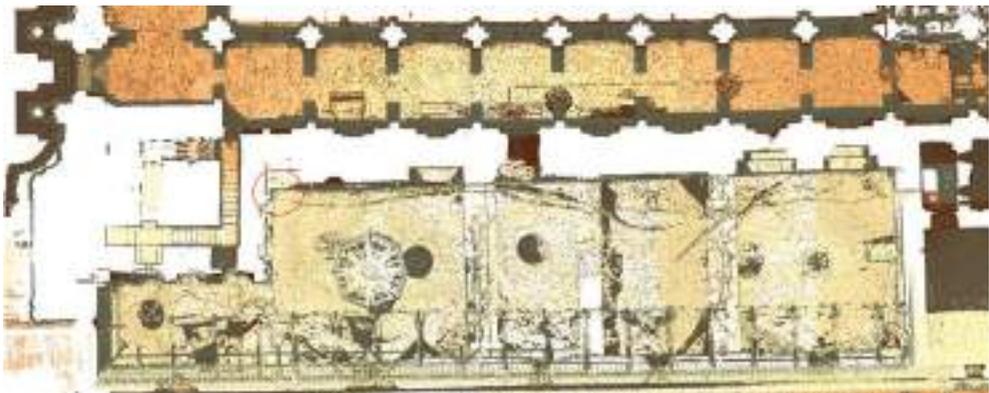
Localización del canecillo y la cuña en el encuentro del muro sur con la torre sur de la fachada del Obradoiro.
